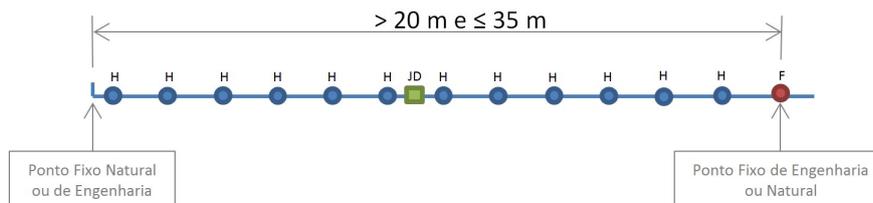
Localização da junta de dilatação entre dois pontos fixos.
